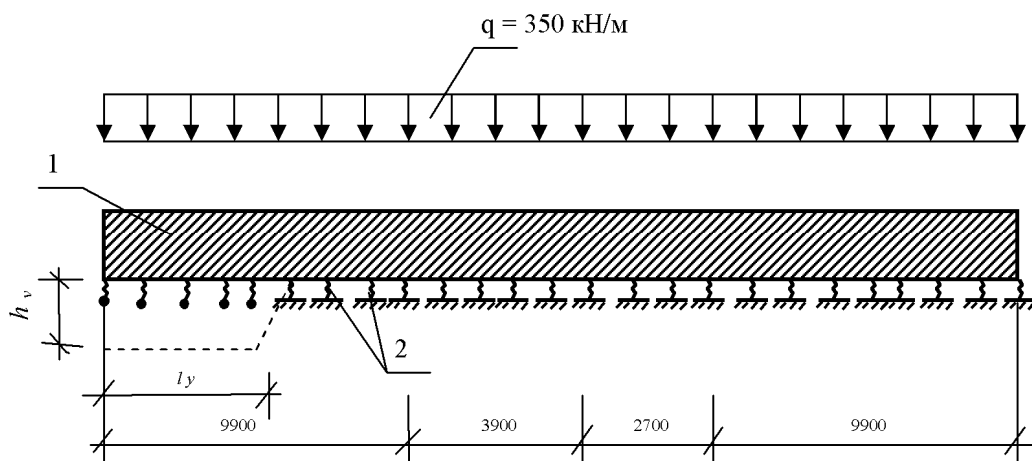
Расчетная схема “фундамент под продольную стену здания – грунтовое основание”
